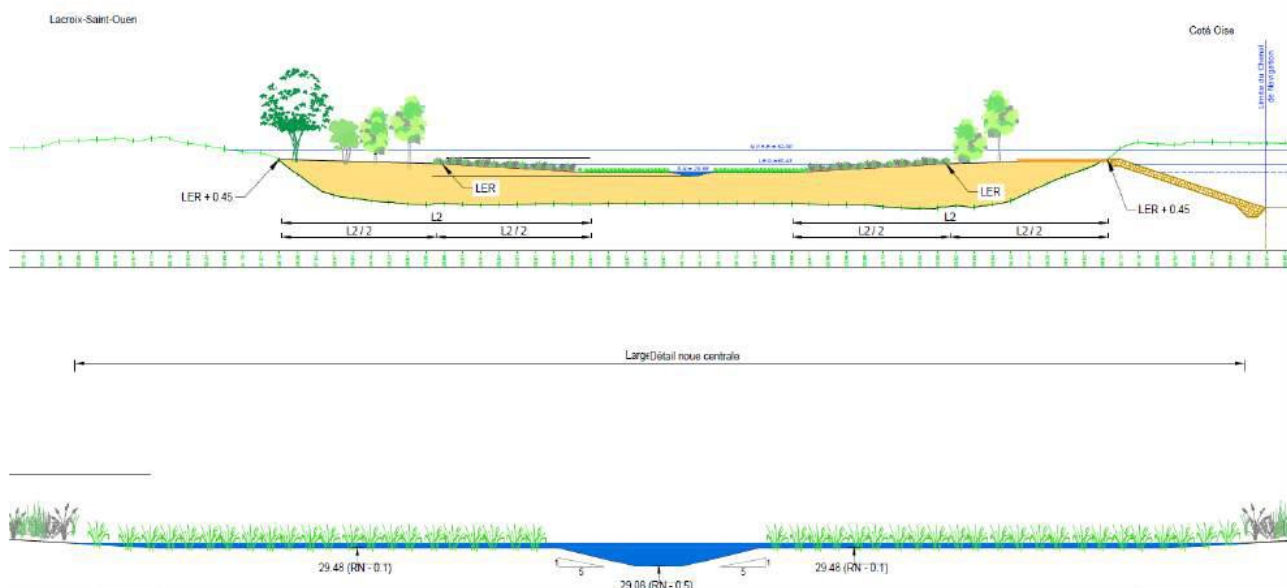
Coupe d'un haut-fond, exemple de Sarron (en jaune, le remblai) – Source : dossier
